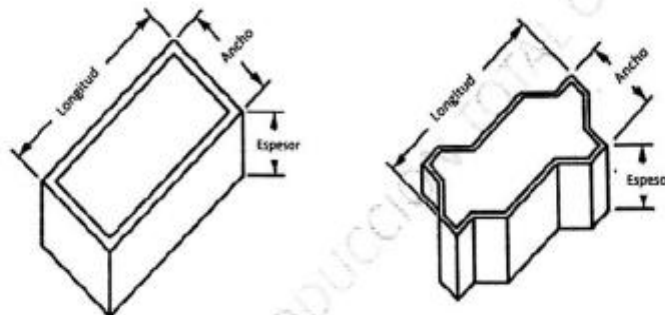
Longitud, ancho y espesor de las unidades de concreto para pavimentos
